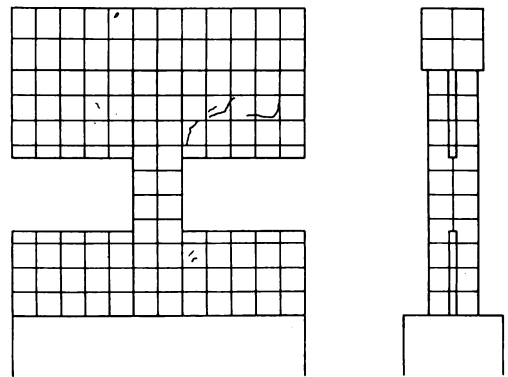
(c) 試験体 CSS03 の初ひび割れ図
